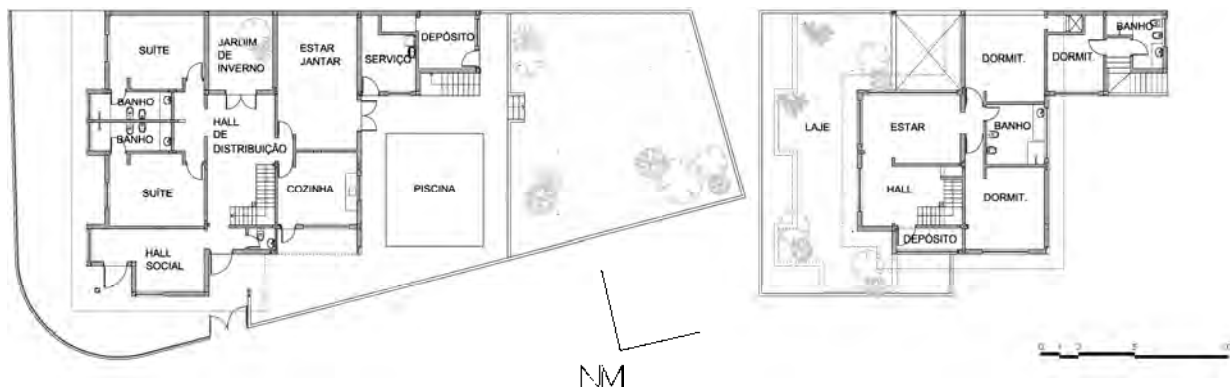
Planta casa 3 – pavimentos térreo e superior.
